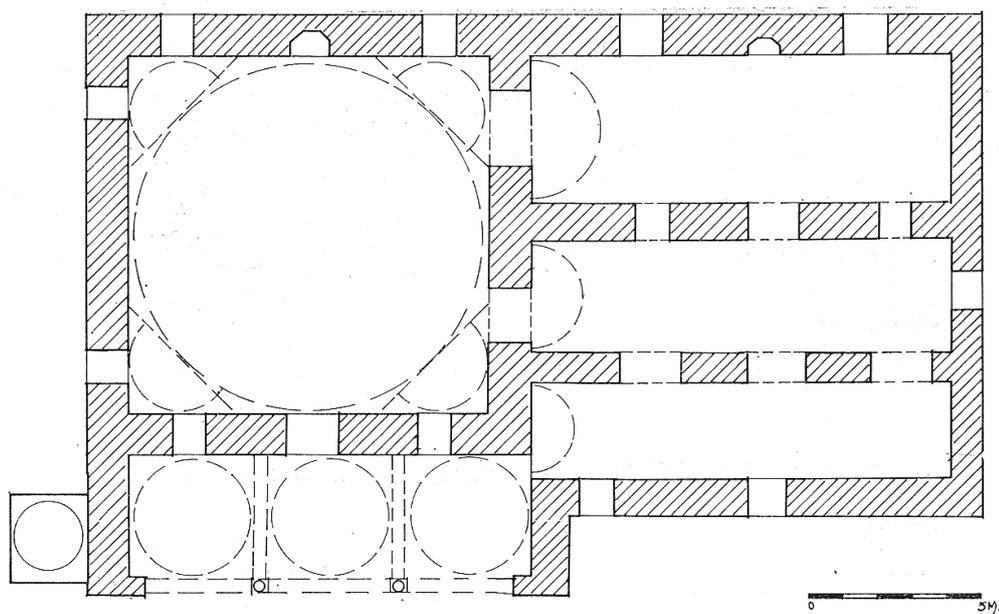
Çermik, Ulu Cami. Pianta (da Altun, 1978)
